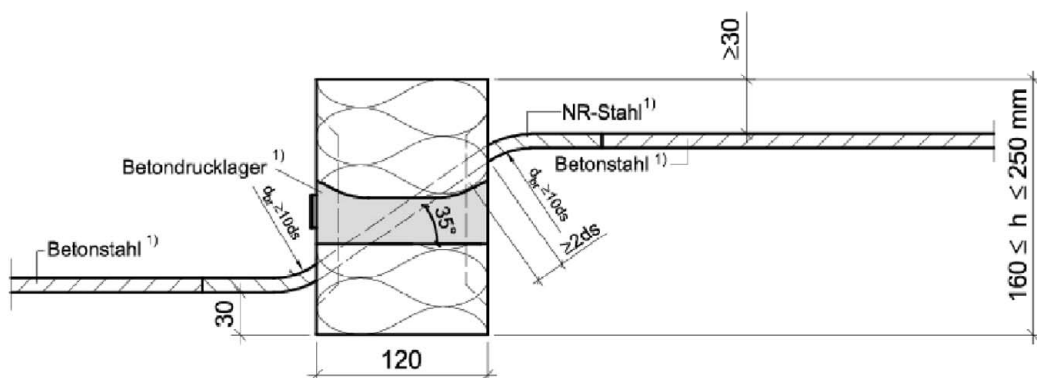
Beispiel Schöck Isokorb® XT Typ Q-ID mit Betondrucklager
